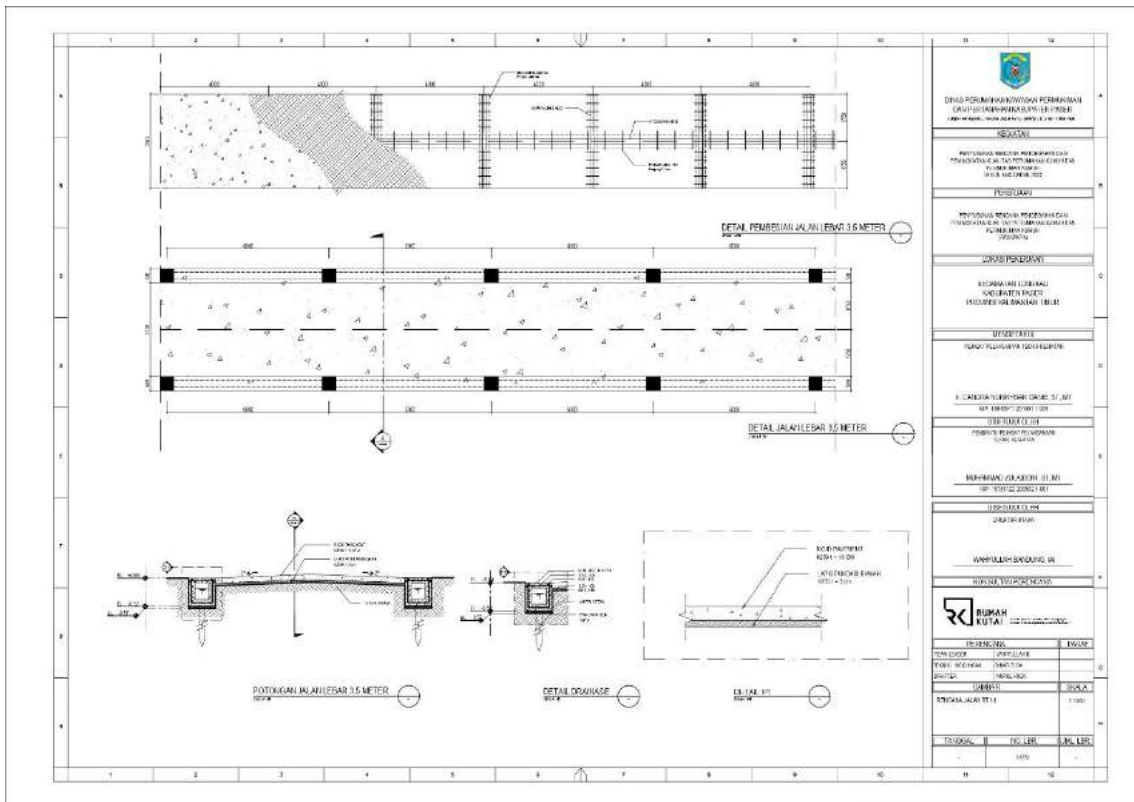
94 Konsep Recana Jalan Segmen 12 RT.14
